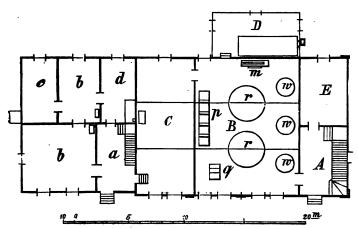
Grundriß eines Delfabrits=Bebaubes nach Anabel.
